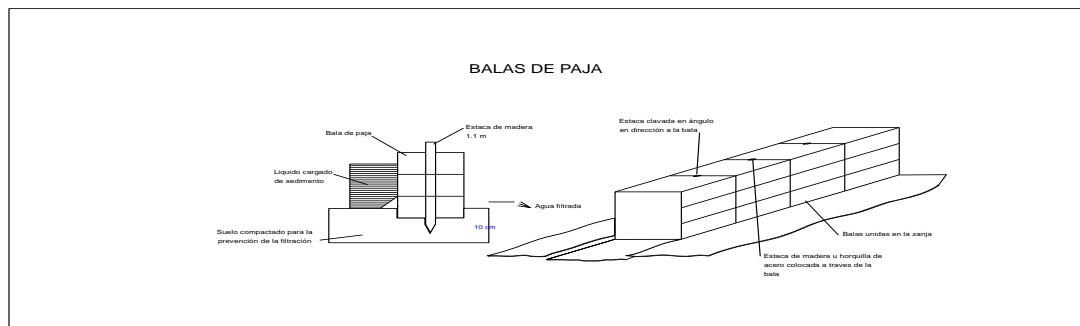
Detalle para la colocación de las balas de paja propuestas. Fuente: Propia
